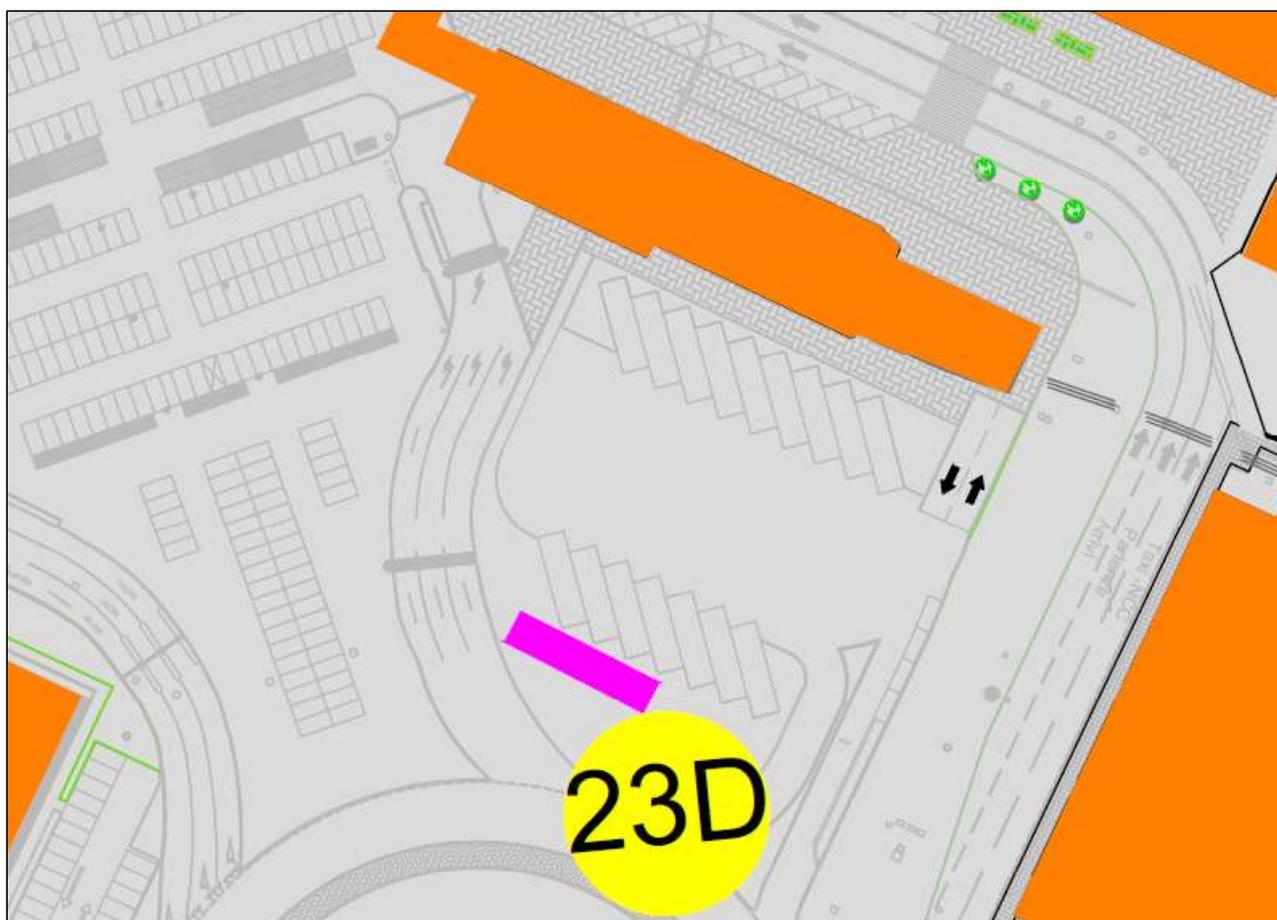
Estratto Master Plan – Spostamento Cabina Subconcessionari
